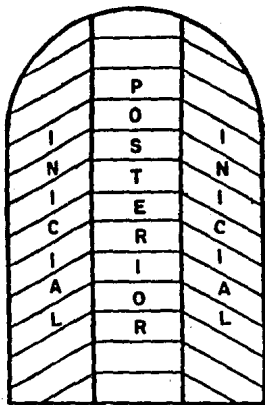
Construcción de túneles con avance por partes (galerías naturales primero y después la parte central).
